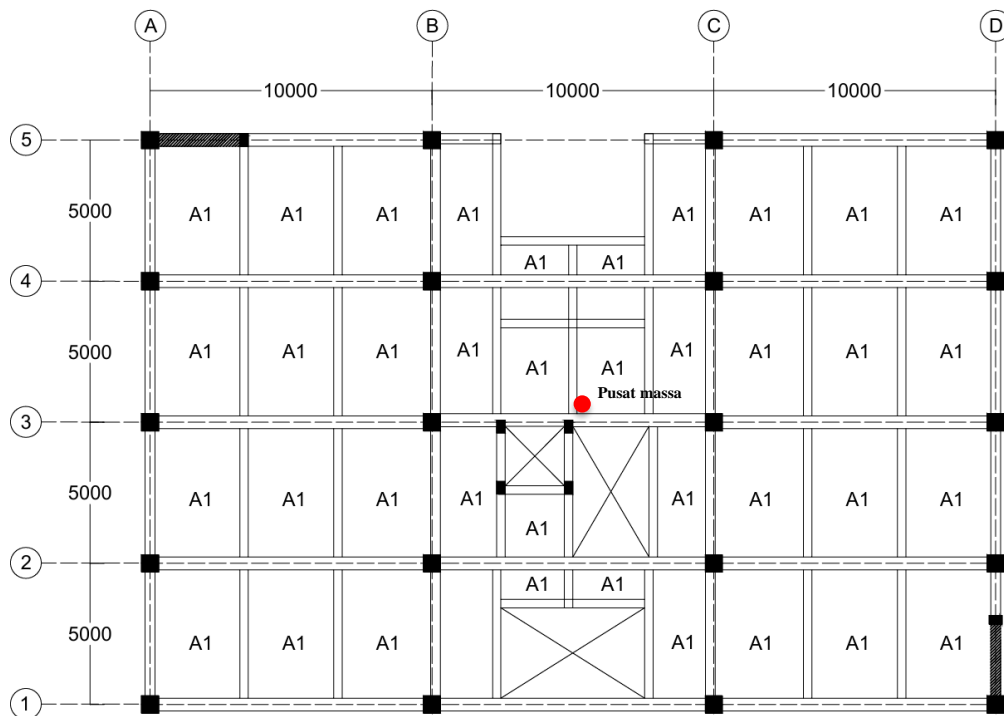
27 Kodifikasi Balok Model 3 Lantai 1 – 3
